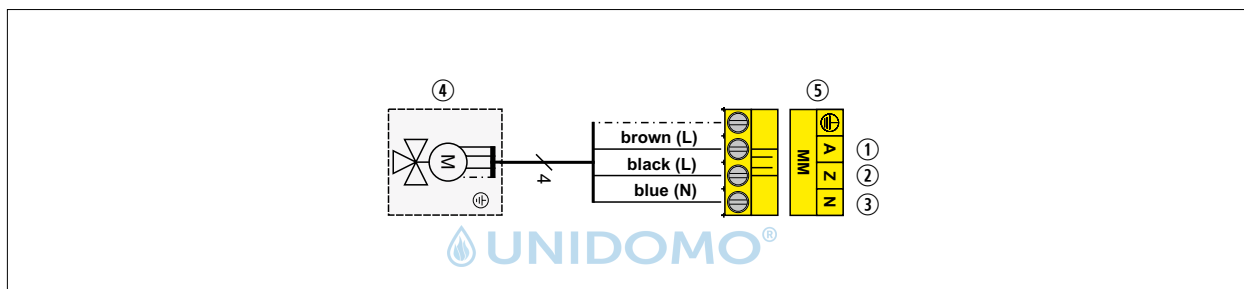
Klemmenbelegung Stellmotor Mischer
